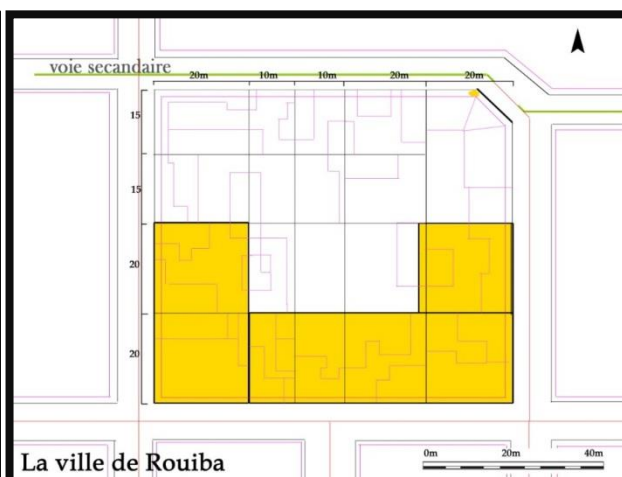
Plan des parcelles donnant sur les voies tertiaires
